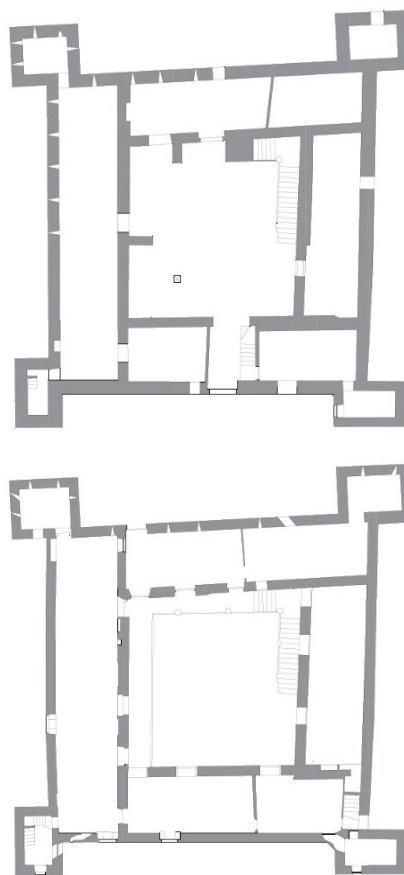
En la imagen superior: Planta baja. En la imagen inferior: Planta noble.
